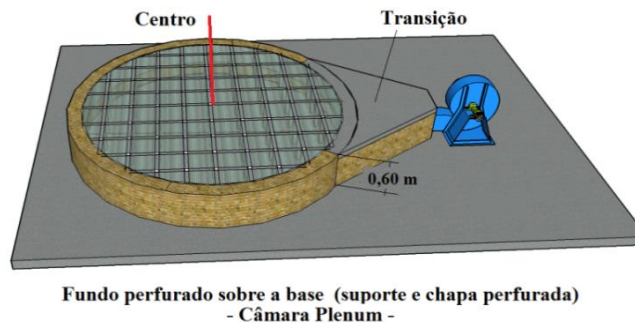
Detalhe da formação da base do secador (câmara plenum, transição e ventilador).
